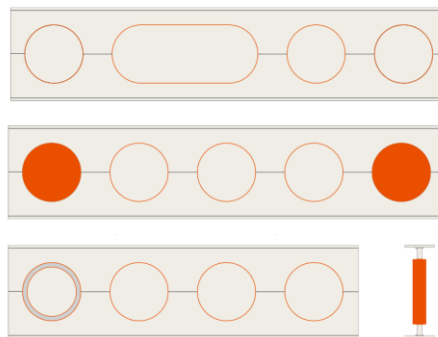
Detalhes construtivos dos alvéolos (adaptado de CONSTRUCTALIA, 2014)
